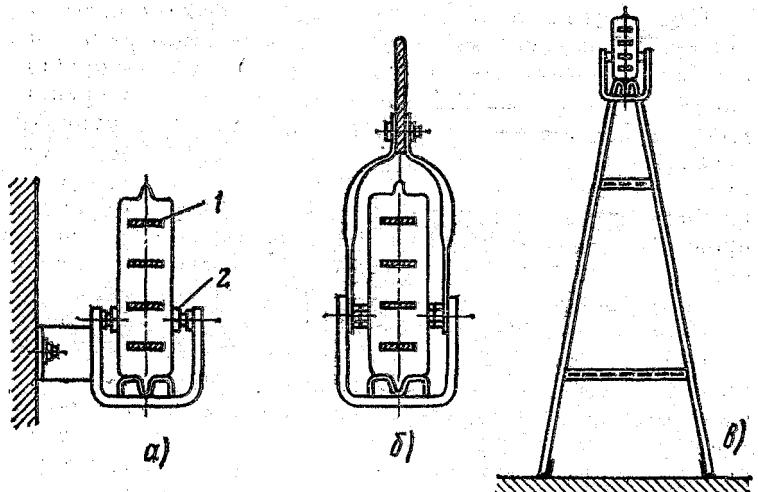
Установка шинопроводов на опорных конструкциях:
